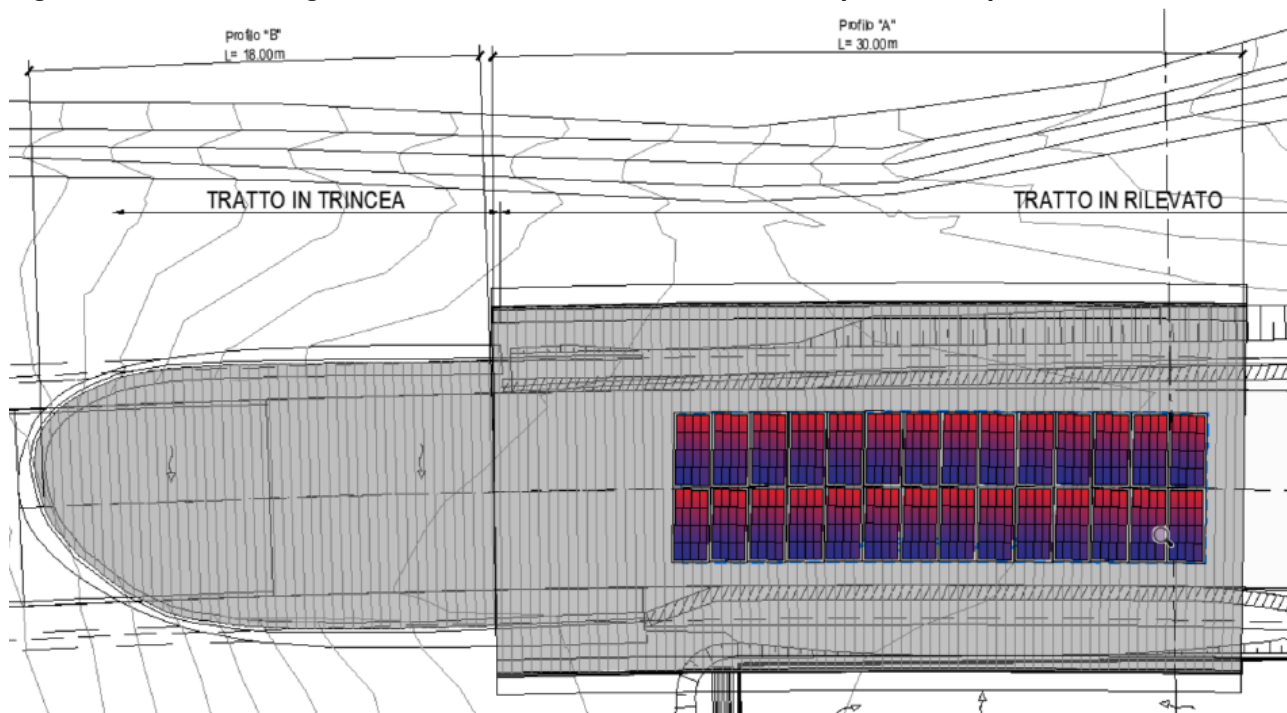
Planimetria copertura antineve all'imbocco lato AQ della canna Ovest.
